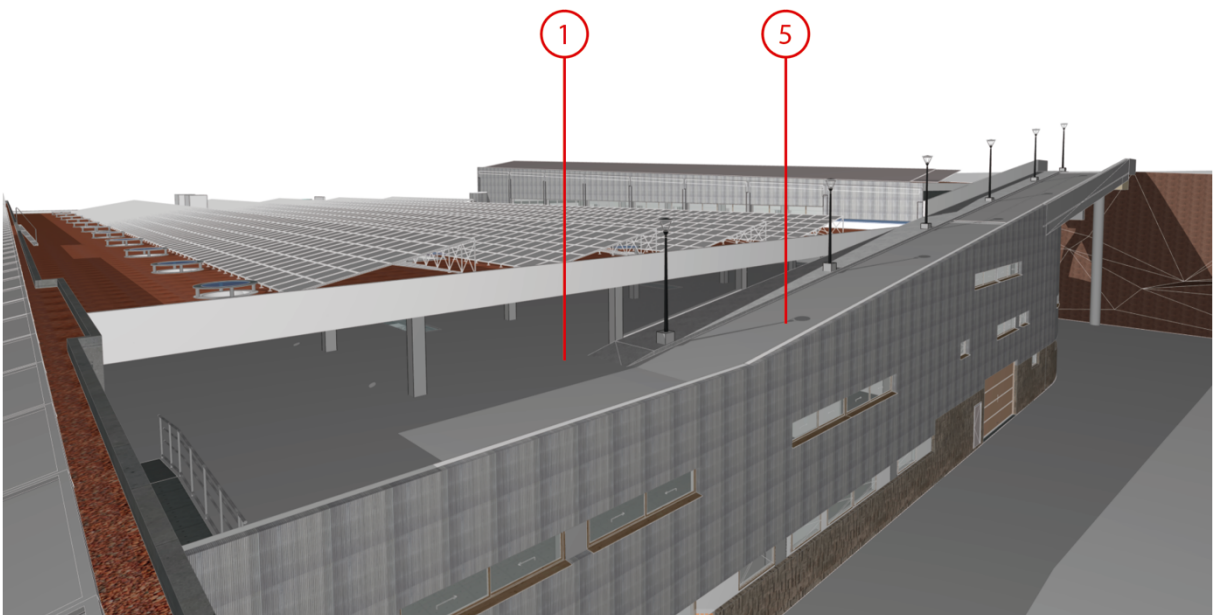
Pavimentación de la rampa. Fuente: Elaboración Propia
